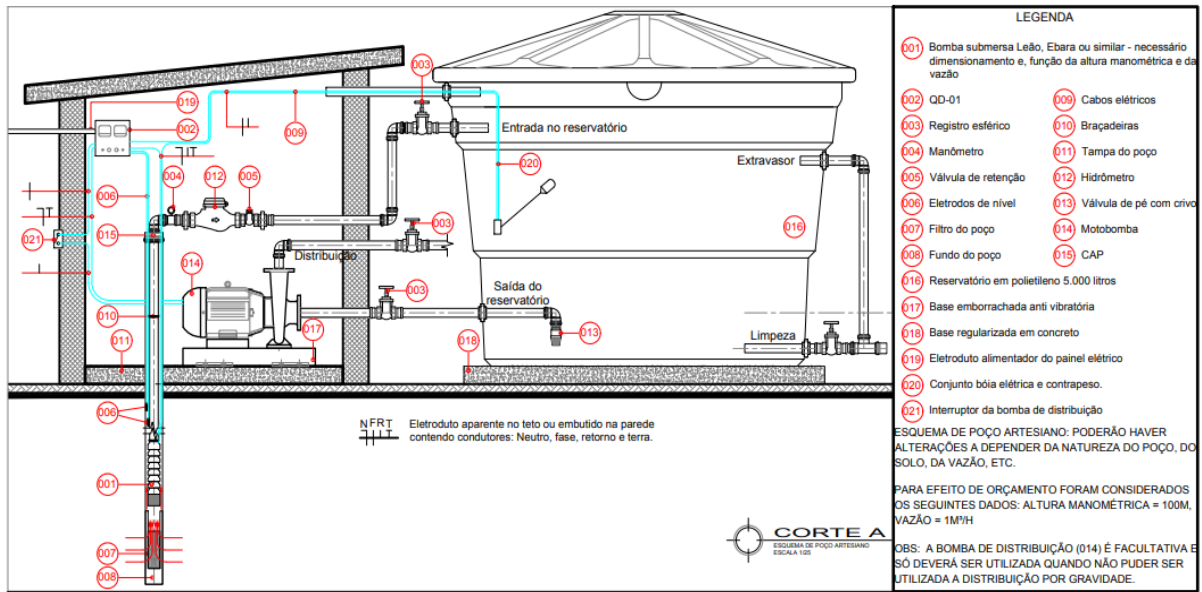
Corte com detalhamentos do projeto executivo de captação de água subterrânea. Fonte: Acervo CMA (2019).
